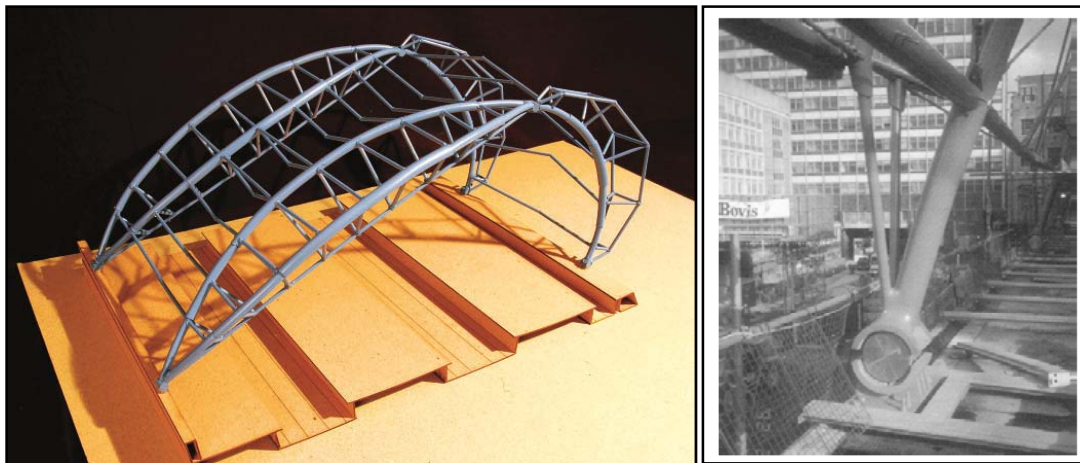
(a) Maqueta del módulo estructural de la estación de Waterloo.
